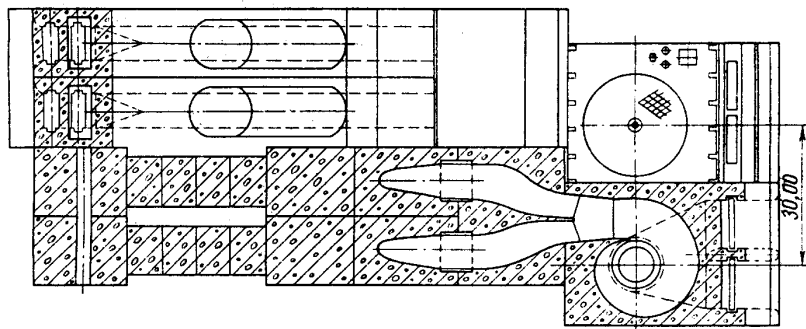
Гидроагрегатный блок с турбинной камерой полного угла охвата
